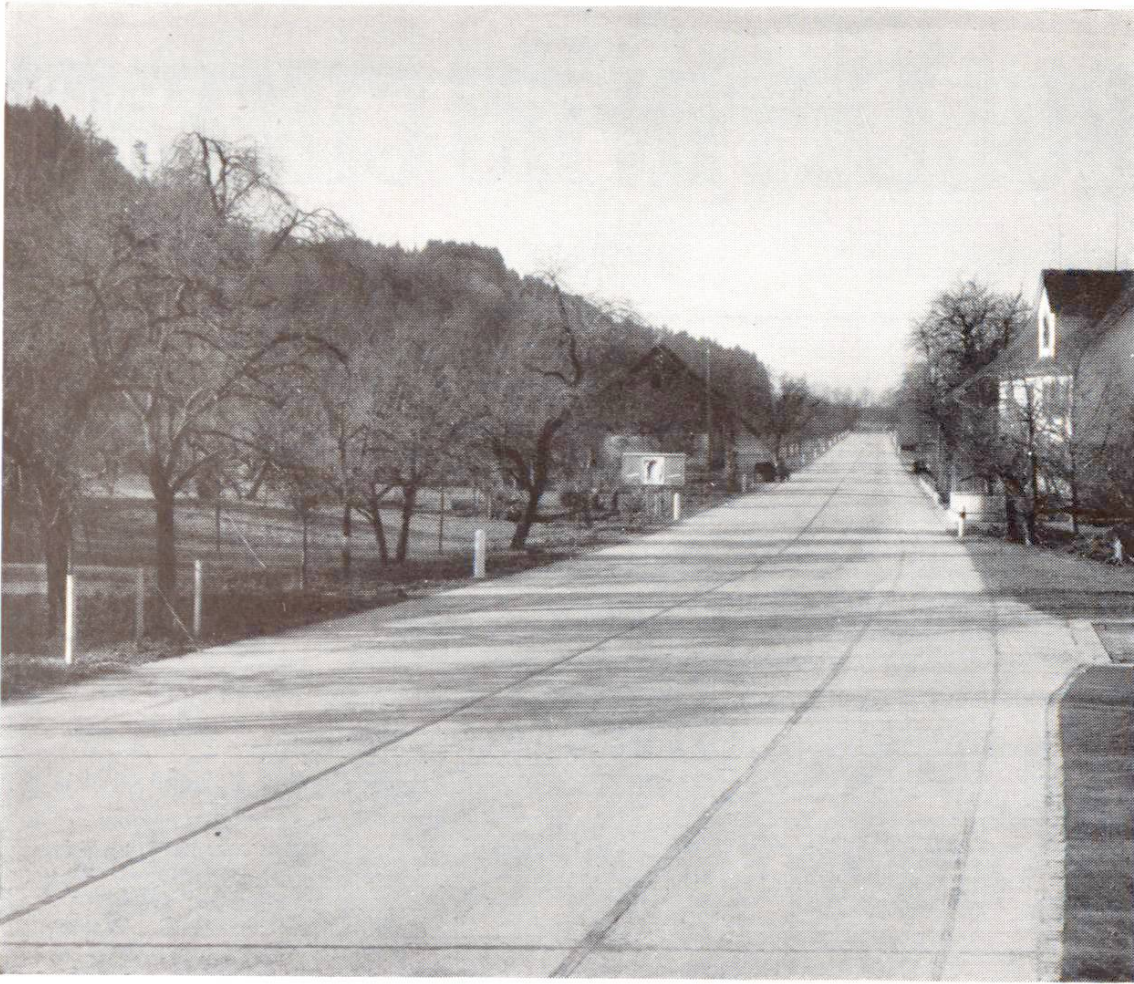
Revêtement en béton avec chaussée de 6,50 m, surlargeur de 2,25 m, ligne de pavés pour jonction avec un revêtement bitumineux, et raccordement à un poids public
